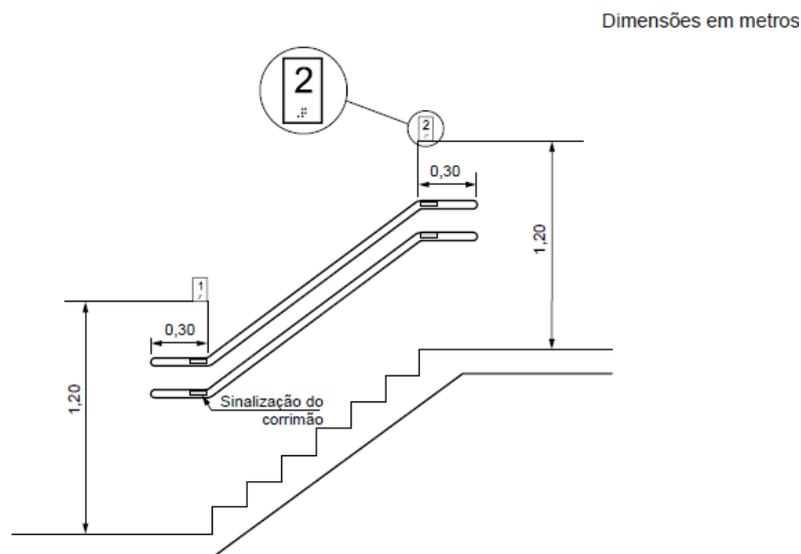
a) - Sinalização de pavimento – Vista Lateral – NBR 9050:2015
